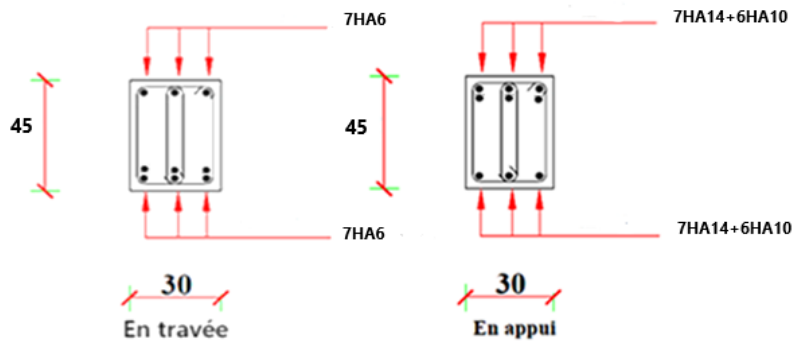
SCHEMA DE FERRAILAGE DE LA POUTRE PRINCIPALE
